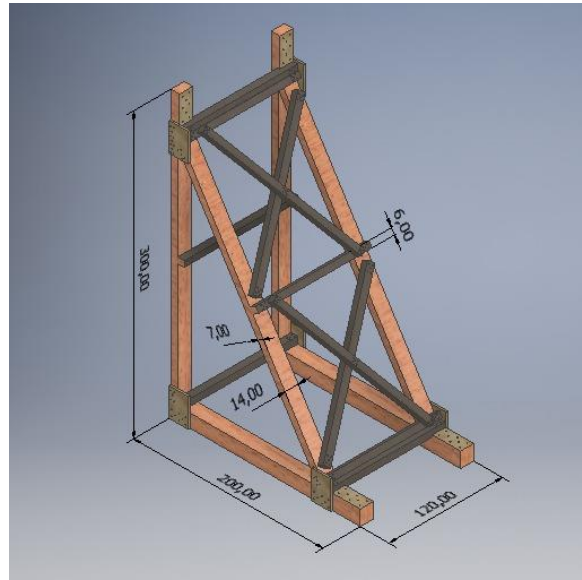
Dimensiones del apuntalamiento tipo Zapata Mural
